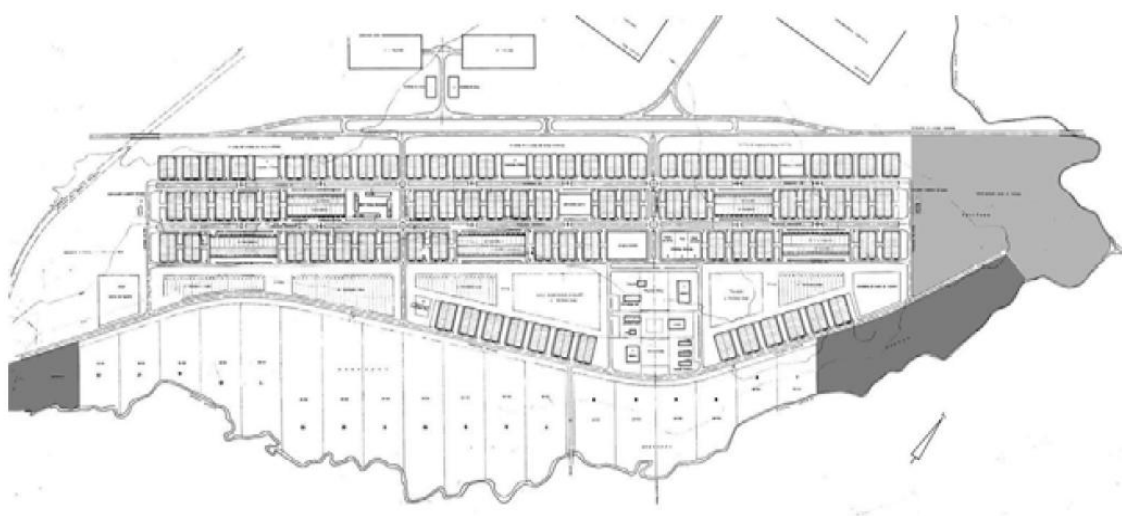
Planta geral do Núcleo Bandeirante, PR 1/1, de 1965.
